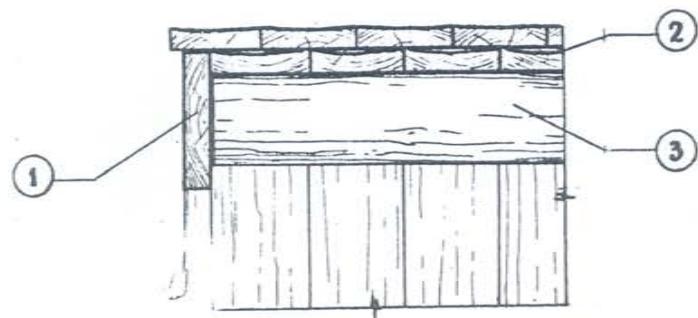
Правильный способ укладки кровельного теса с устройством свеса над причелиной (разрез):
